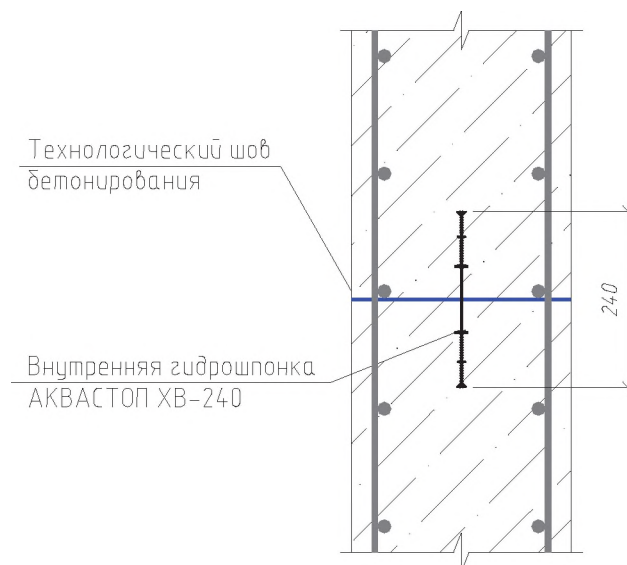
Гидроизоляция технологического шва бетонирования (вариант 3)
